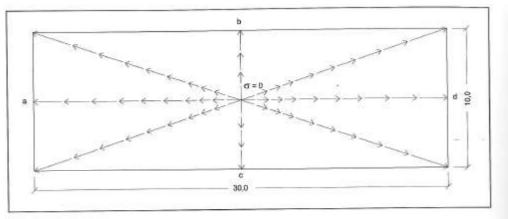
Planta de cubierta. Distribución de tensiones.
